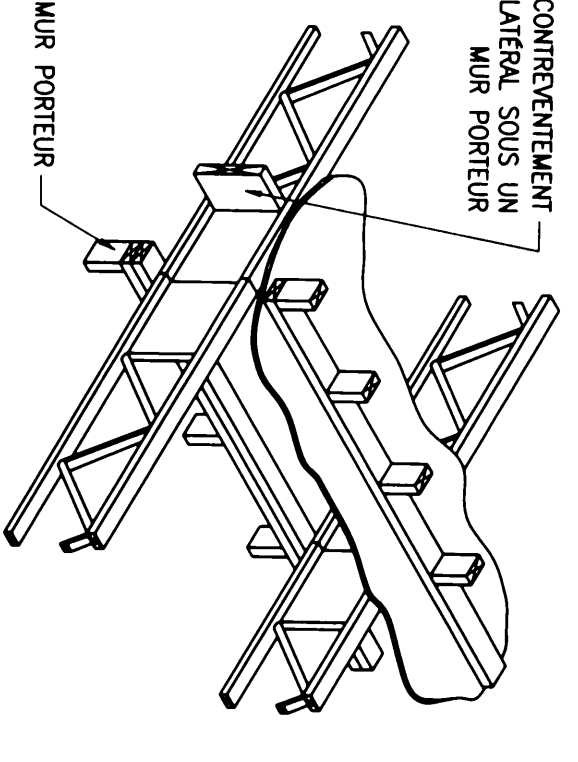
DETAIL TYPIQUE POUTRES DE RIVE PARALLELES AUX POUTRELLES
